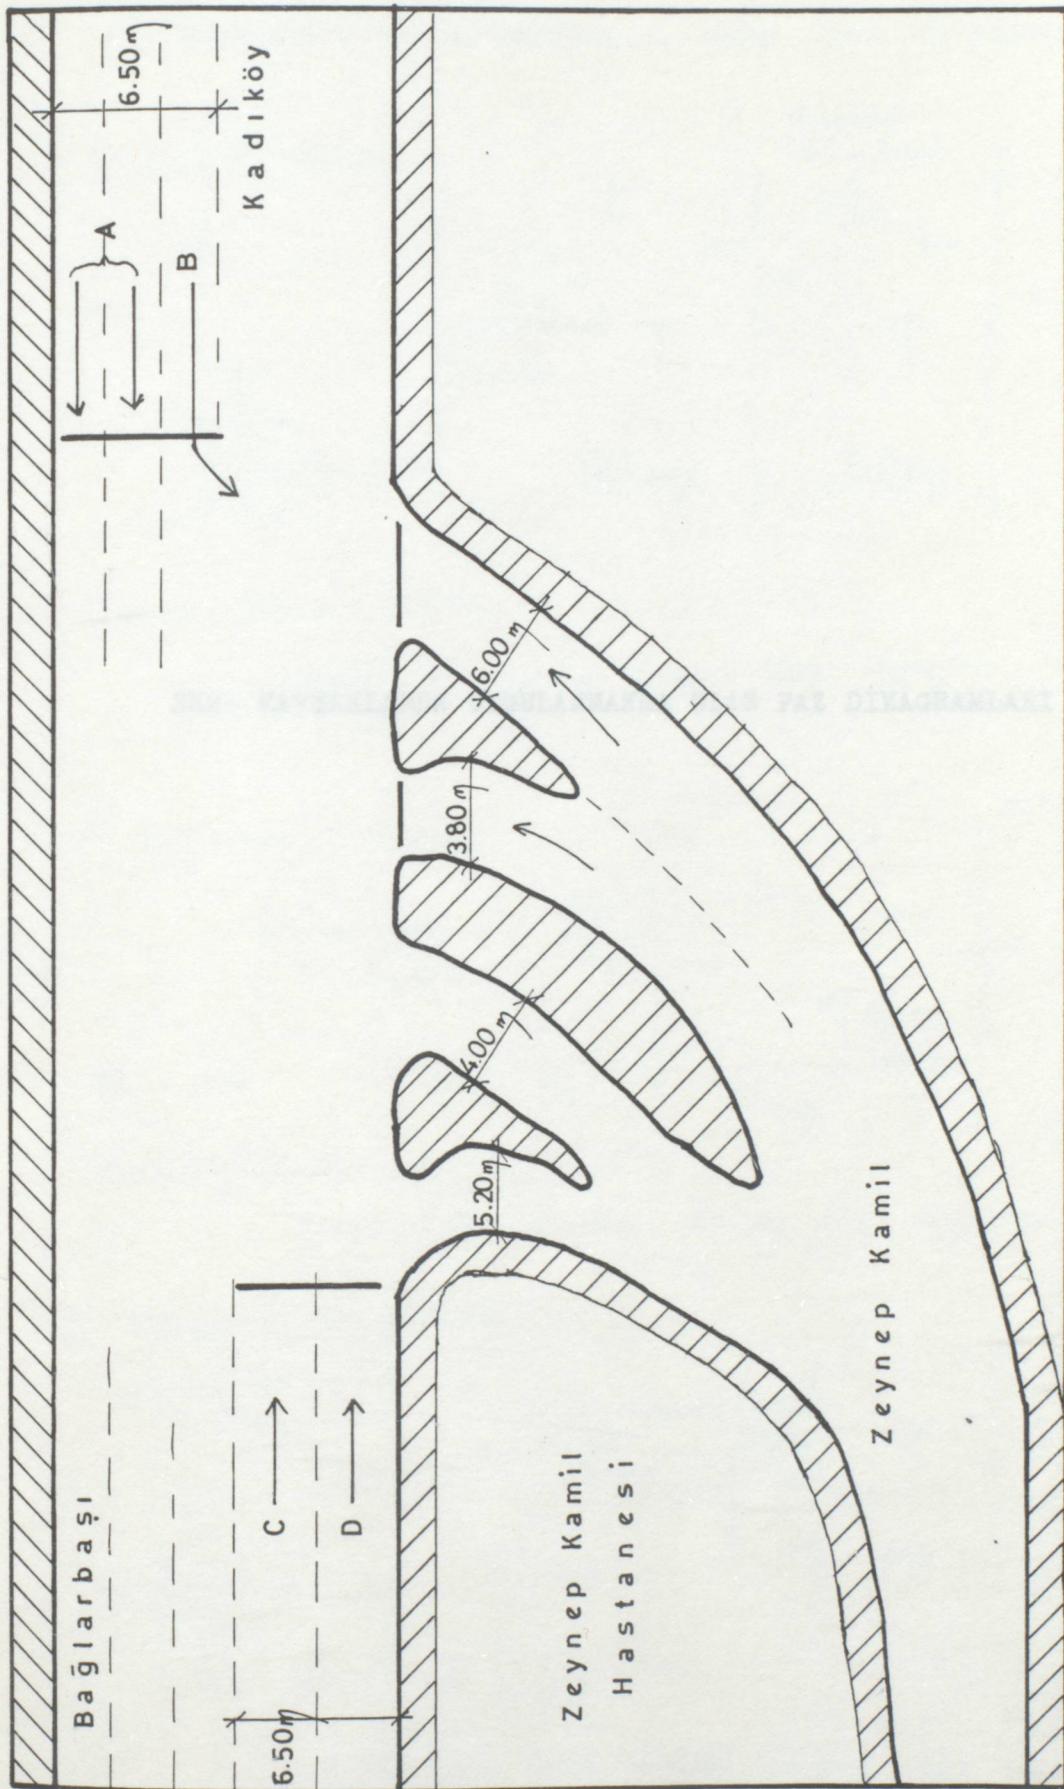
YILDIZ BAKKAL KAVŞAĞI PLAN VE ÖZELLİKLERİ
